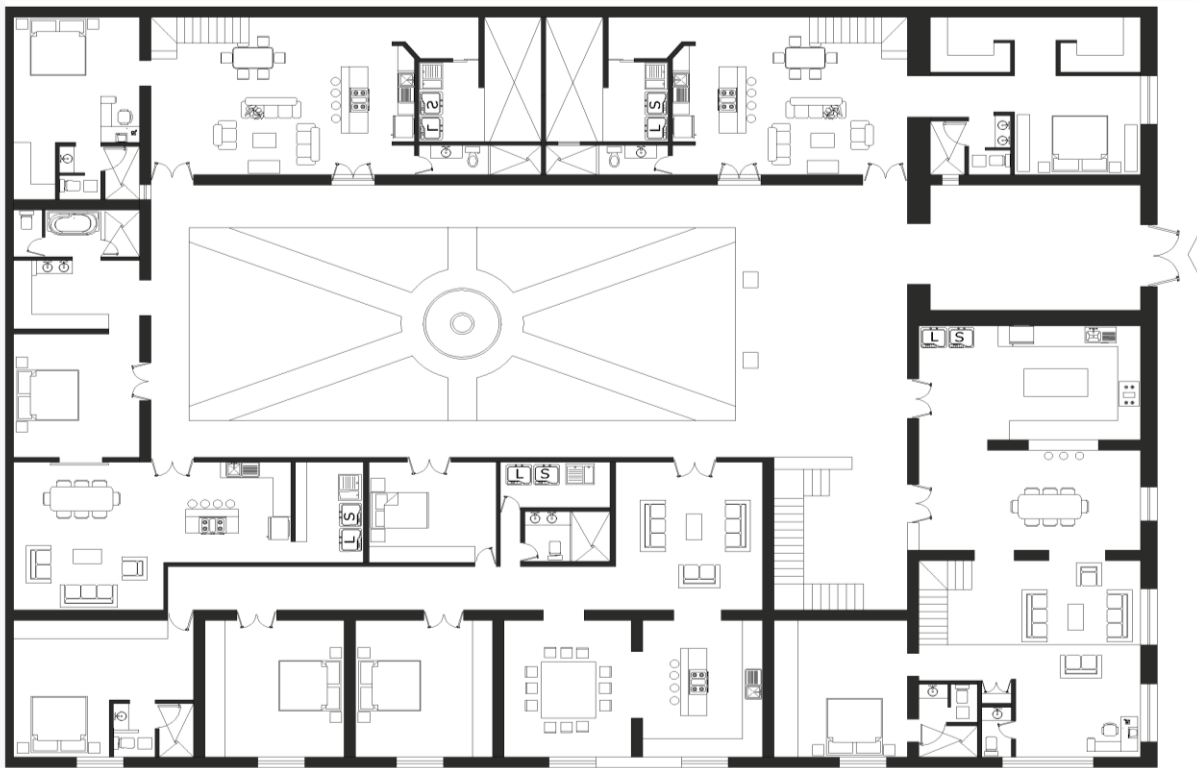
Distribución de Diseño Arquitectónico de las 5 viviendas
